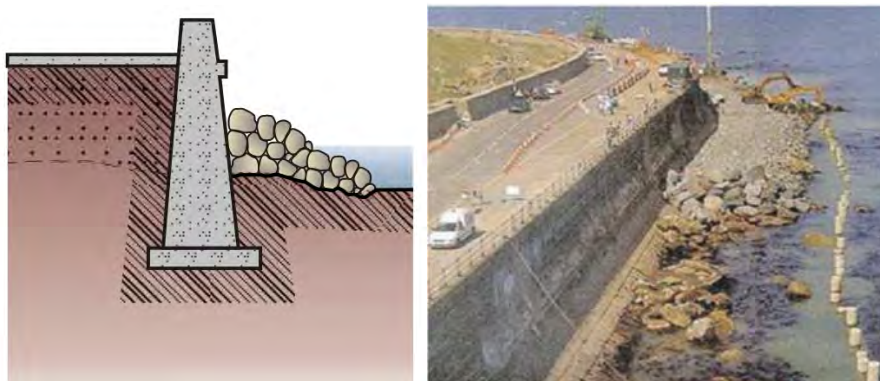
Muro verticale in calcestruzzo con protezione al piede con massi naturali (APAT, 2007).
